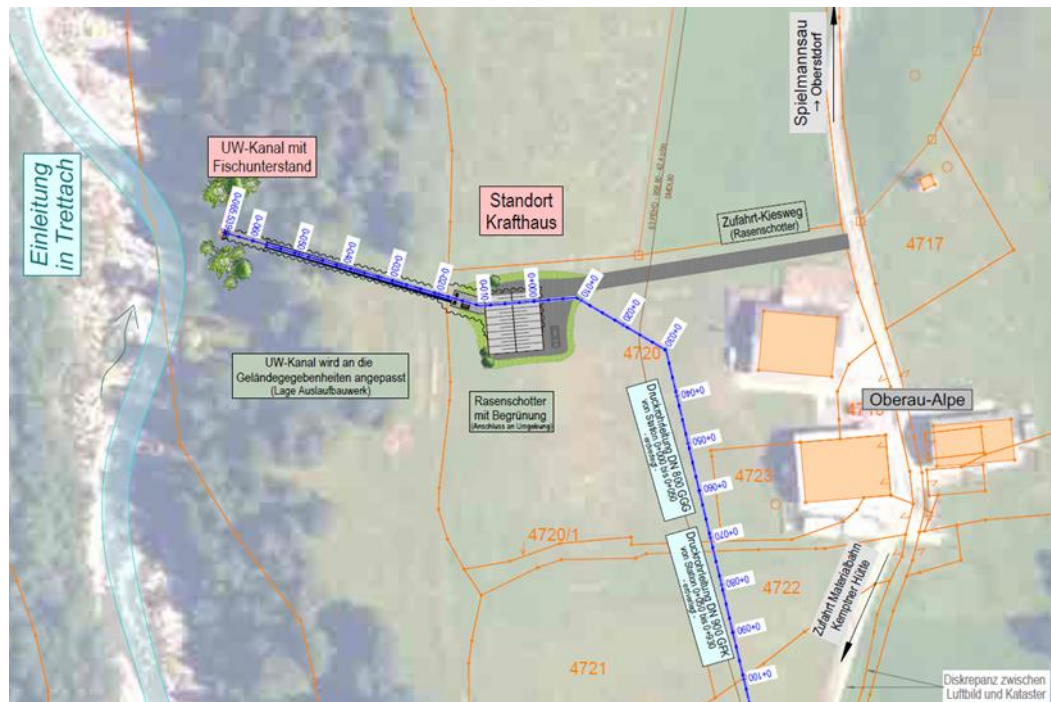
Lageplan mit Krafthaus und Triebwasserrückführung
